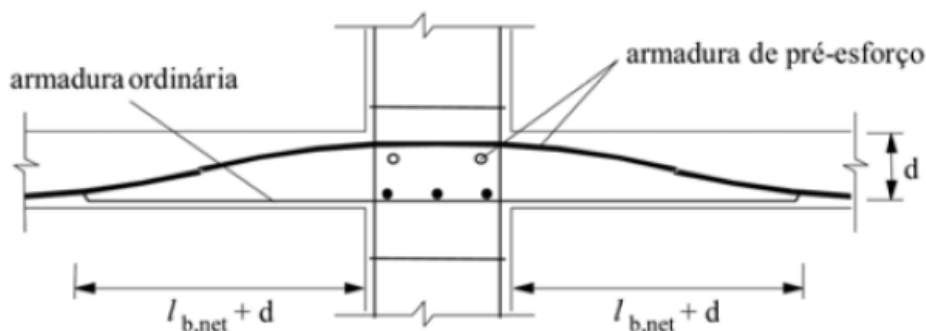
Armadura de colapso progressivo em pilar interior [B18]
